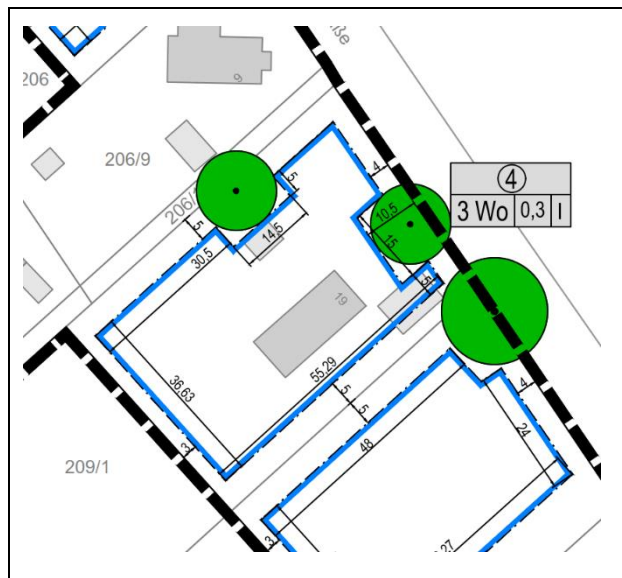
Hausnummer 19 - Lageplan (o.M.)
